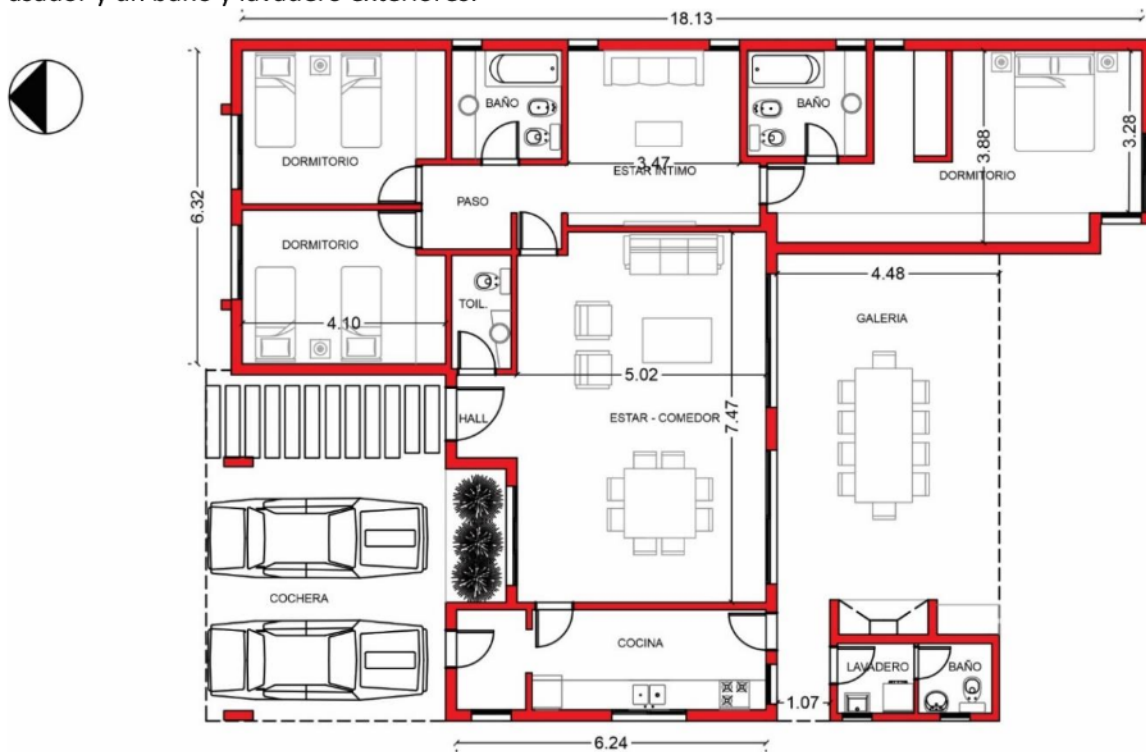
Planimetría del caso de análisis. Fuente: elaboración propia a partir de planimetría otorgada por el proyectista.
